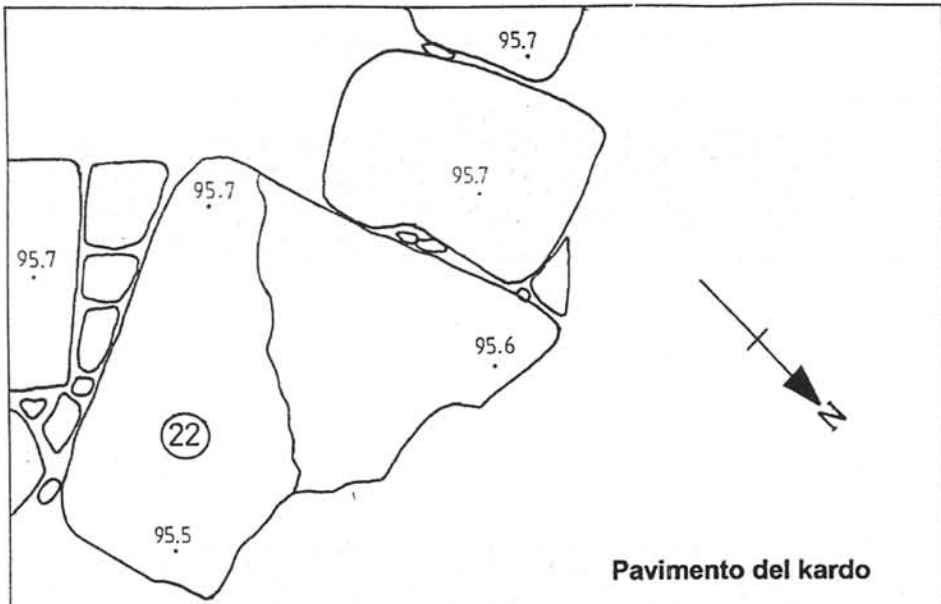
Planimetría del pavimento y la cloaca del kardo detectado en el Corte 3.
